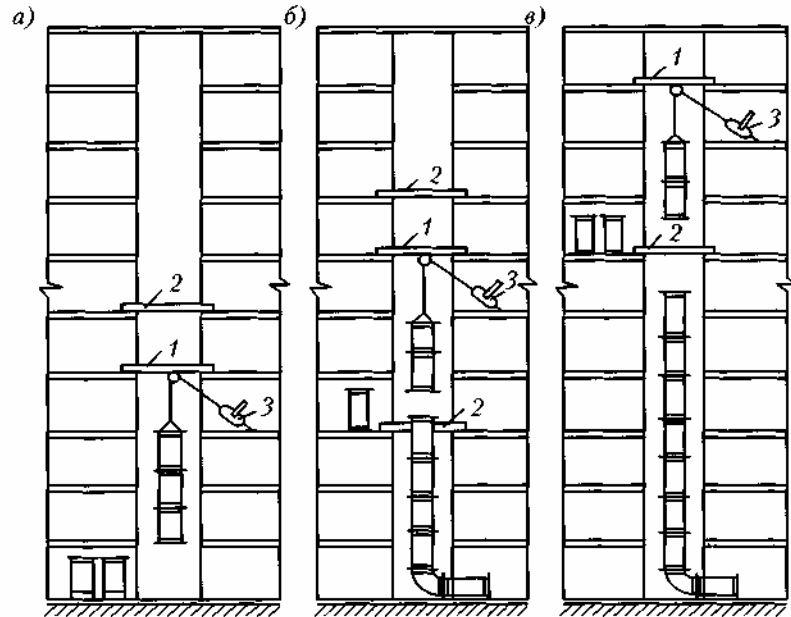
Последовательность (а, б, в) монтажа вертикальных воздуховодов комбинированным методом: 1 — грузовая балка; 2 — настил; 3 — лебедка
